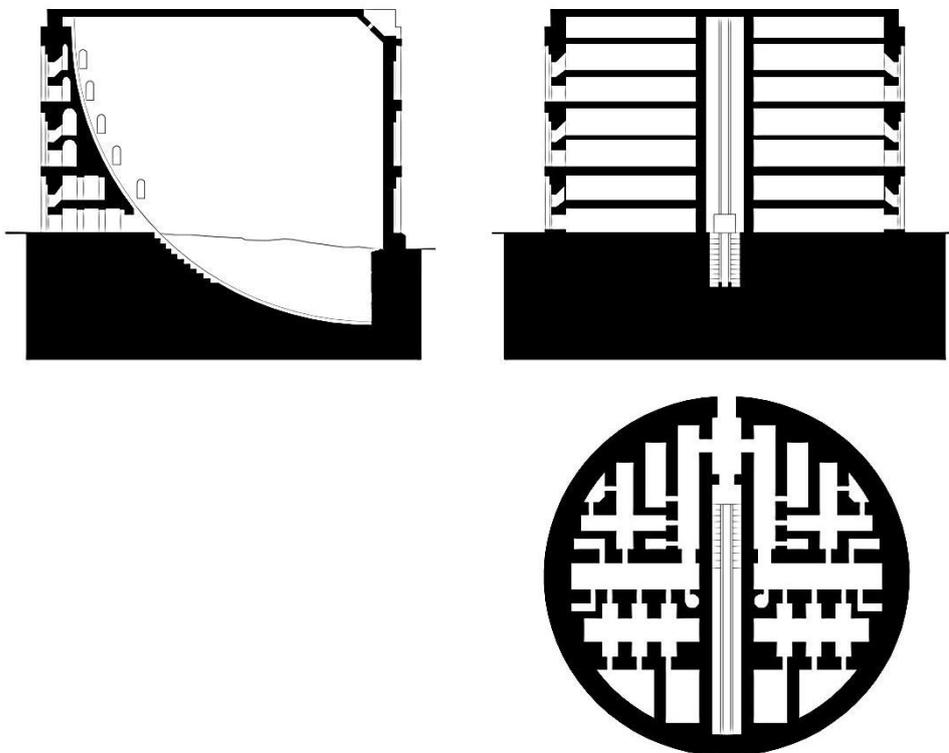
Observatorio de Samarcanda. Planta y secciones.
